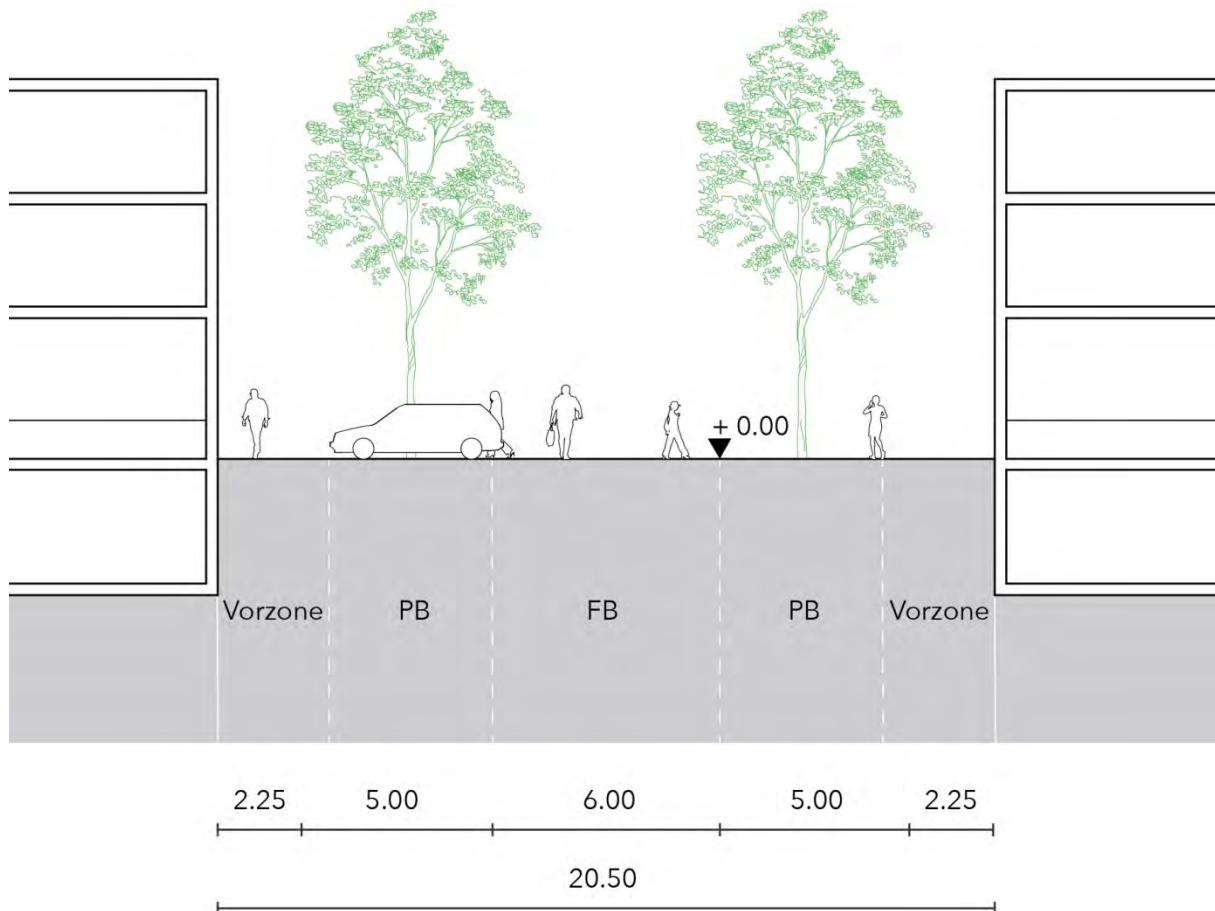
Straßenquerschnitt Wohnweg östlich Römerstraße, Quelle: Teleinternetcafé GbR / TH Treibhaus
